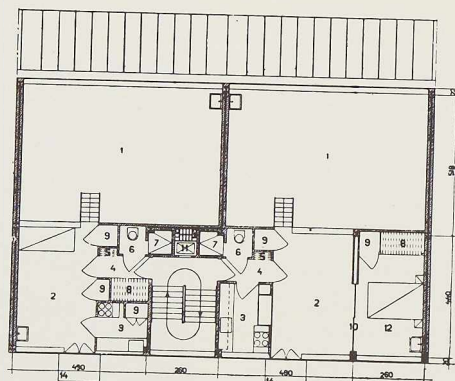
Plan du rez-de-chaussée et de l'étage intermédiaire.
